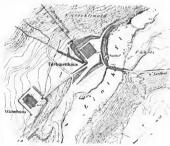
Lageplan der Kraftzentrale. - Masstab 1 : 2000.
